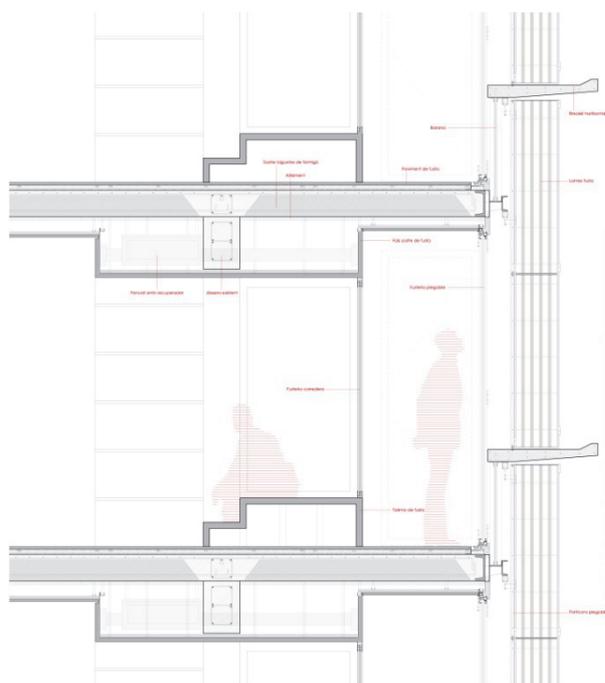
Detalle constructivo de fachada para la propuesta del hotel Panorama Park con diferentes filtros de sombra y ventilación.
